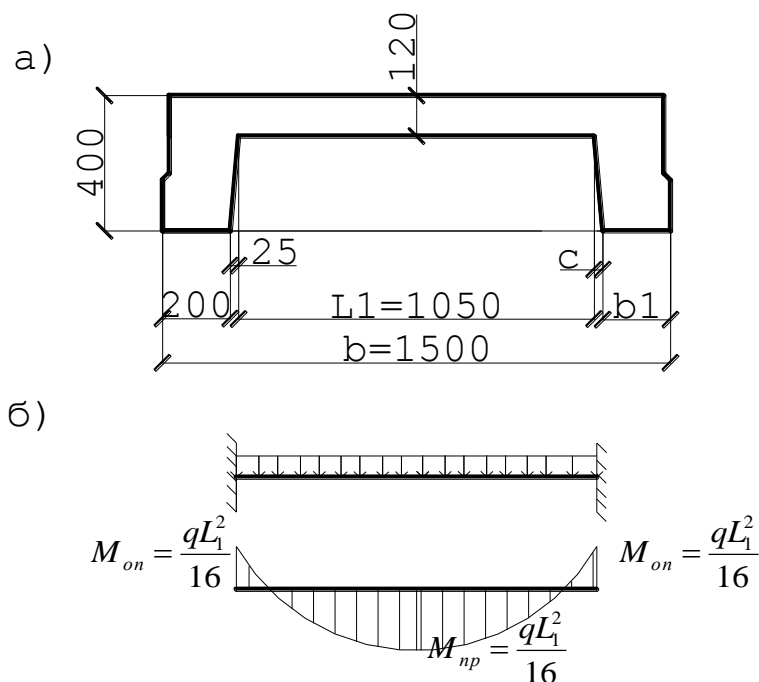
а) Расчетное поперечное сечение плиты перекрытия б) Расчетная схема и эпюра изгибающих моментов в полке плиты перекрытия
